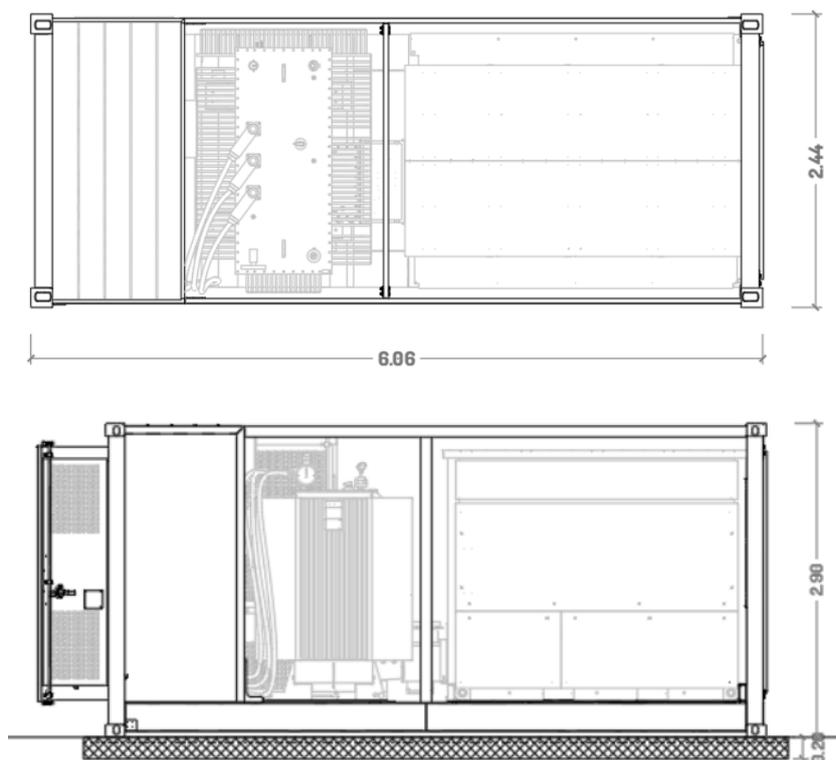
Pianta e Sezione del Power Skid da 4600 kVA
